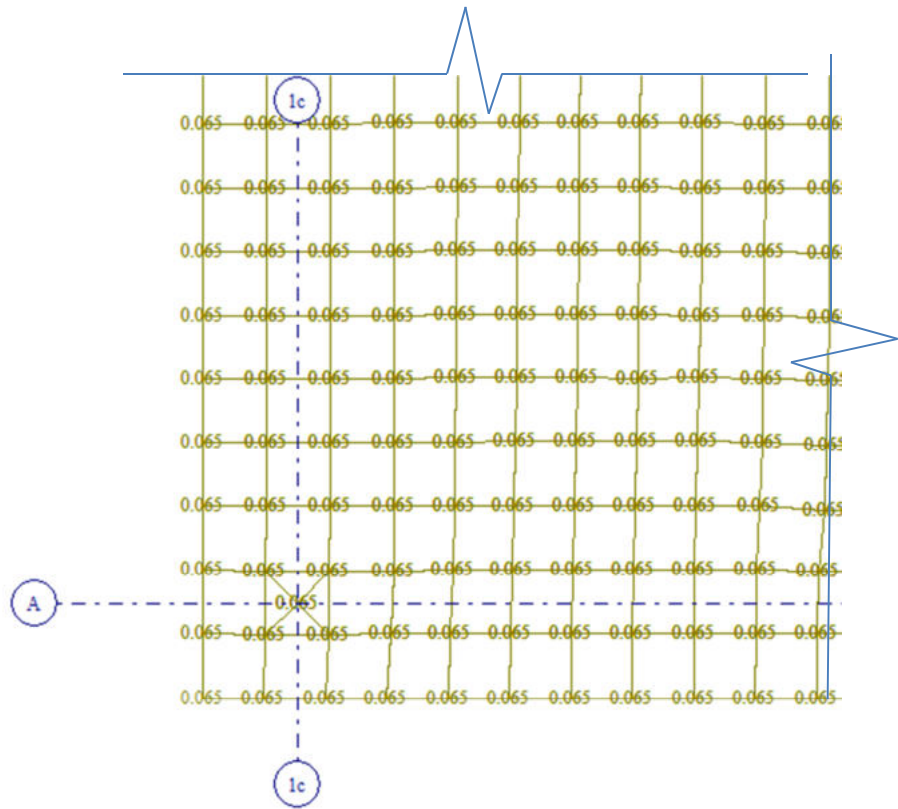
Фрагмент плиты с указанием нагрузок от веса перегородок
